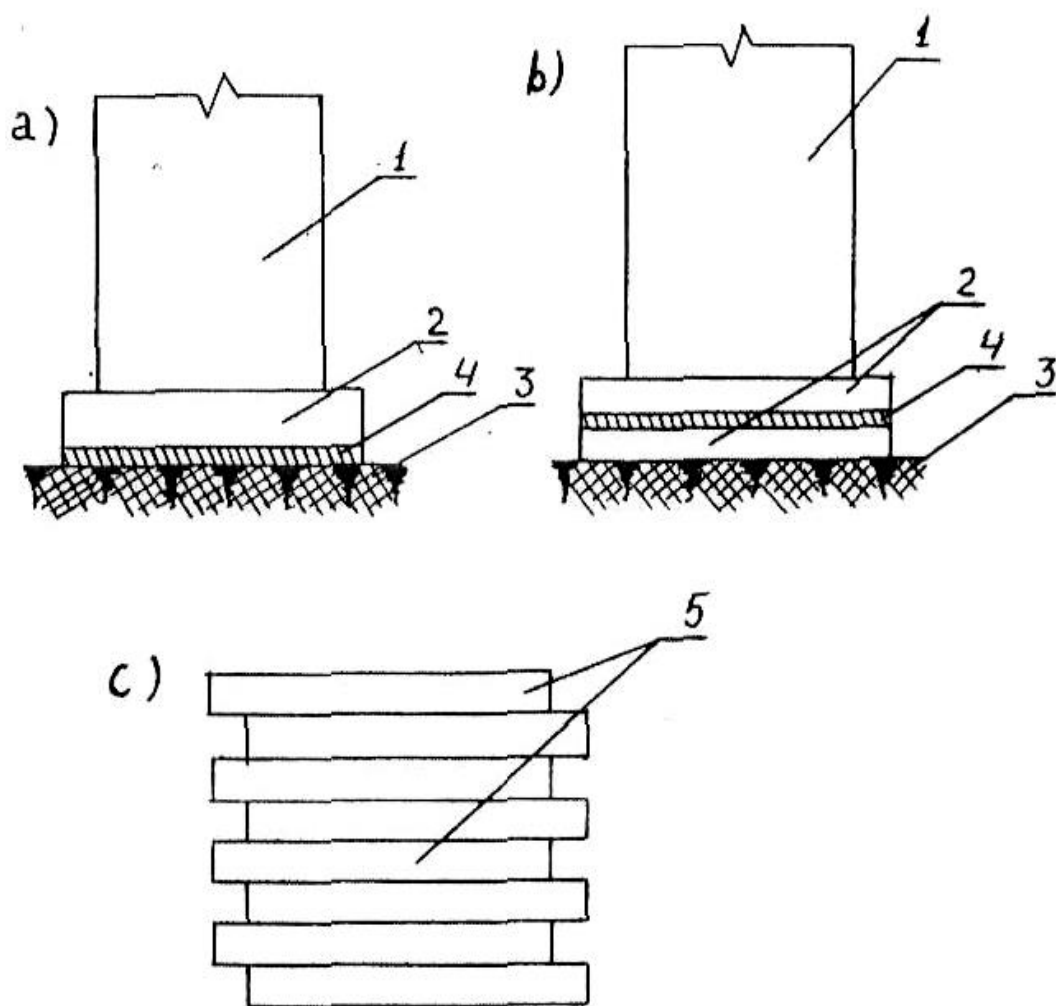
Сейсмоизоляционные маты из протекторных обрезков утилизированных металлокордных покрышек: а) расположение сейсмоизоляционного мата между фундаментом с основанием здания; б) расположение сейсмоизоляционного мата внутри фундамента здания; в) собранный элемент мата.
